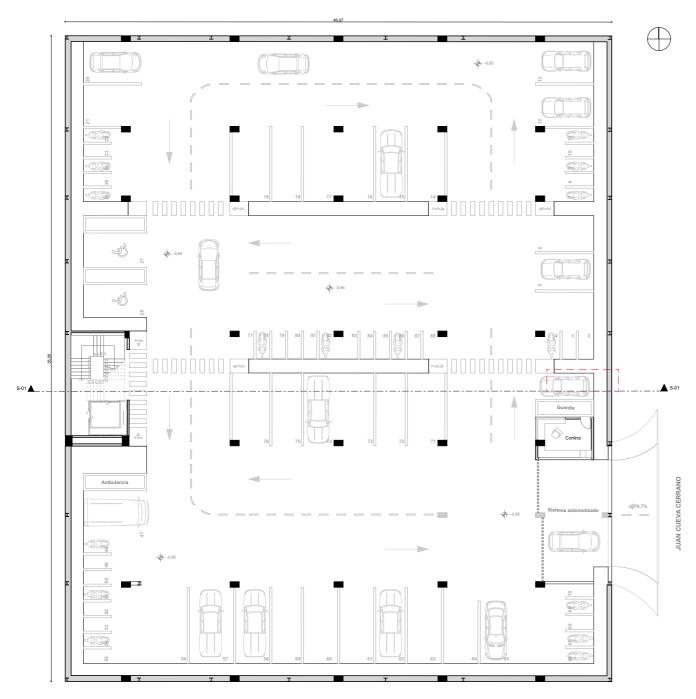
Bloque 1 - planta de estacionamiento ESC_1:325 Elaborado por: Autor
